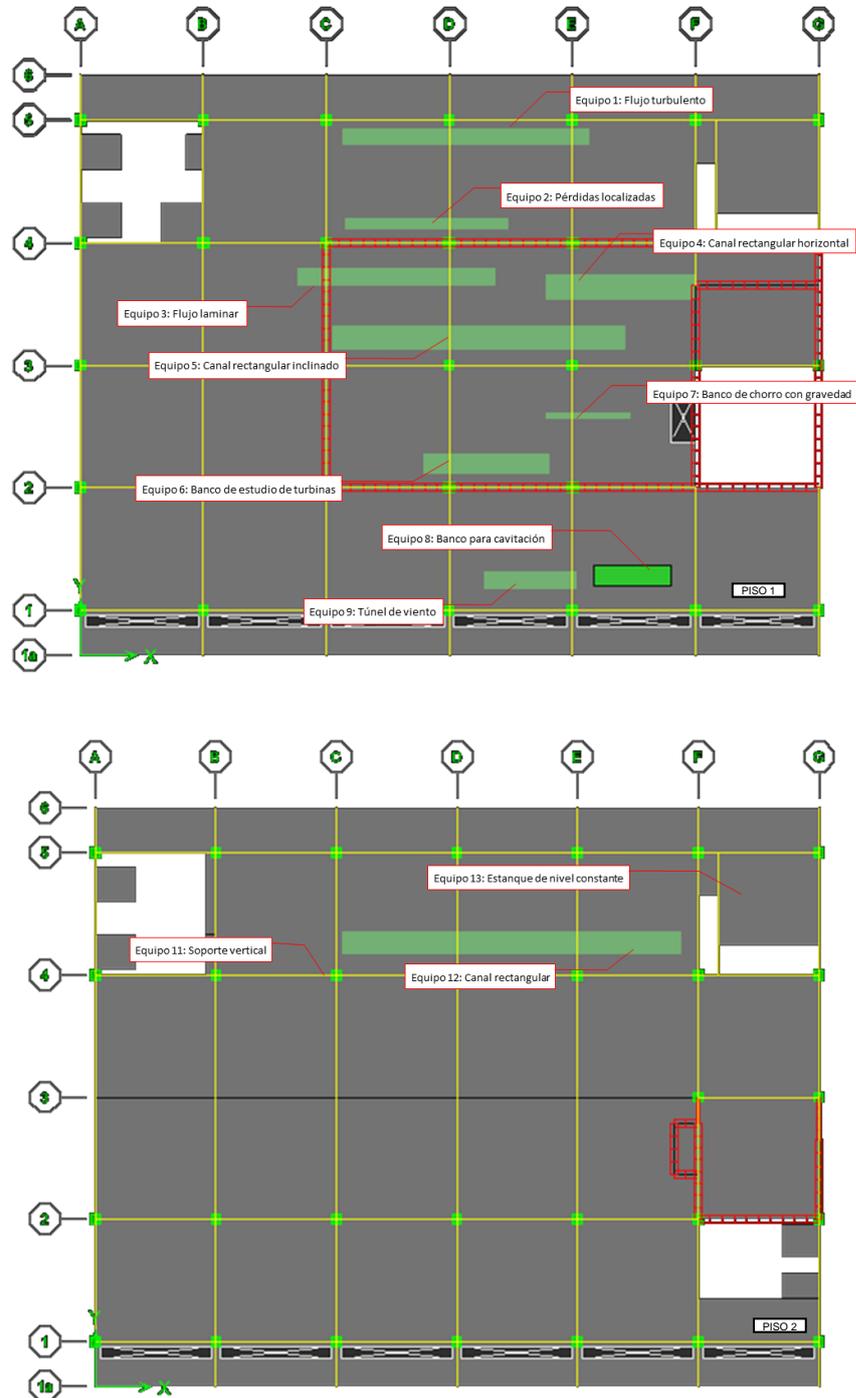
Disposición de los equipos dentro del Laboratorio de Hidráulica (piso uno y piso 2). Elaboración propia.
